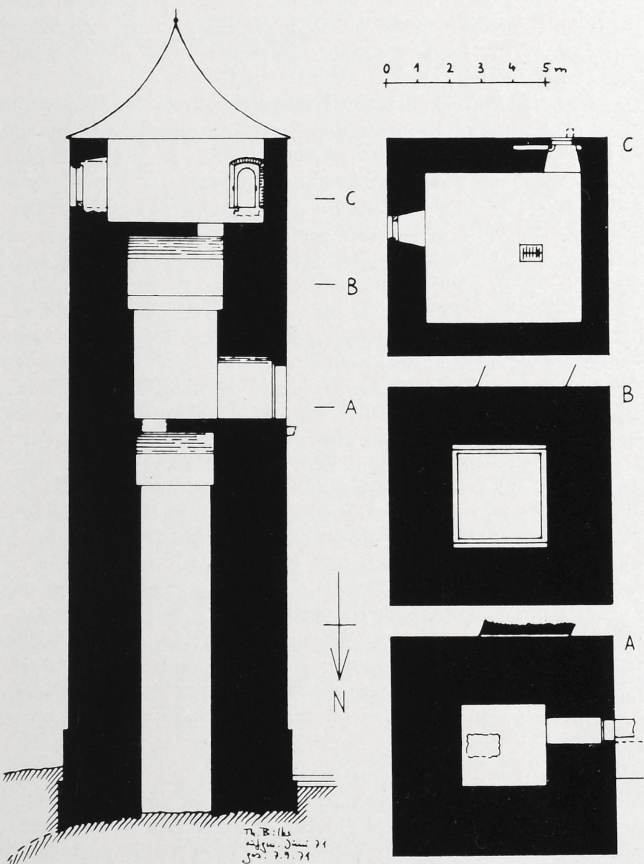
Bergfried, Schnitt Ost-West und Grundrisse in drei Höhen⁵²⁾. Die hölzernen Einbauten (Treppen) und der Treppenturm sind weggelassen
